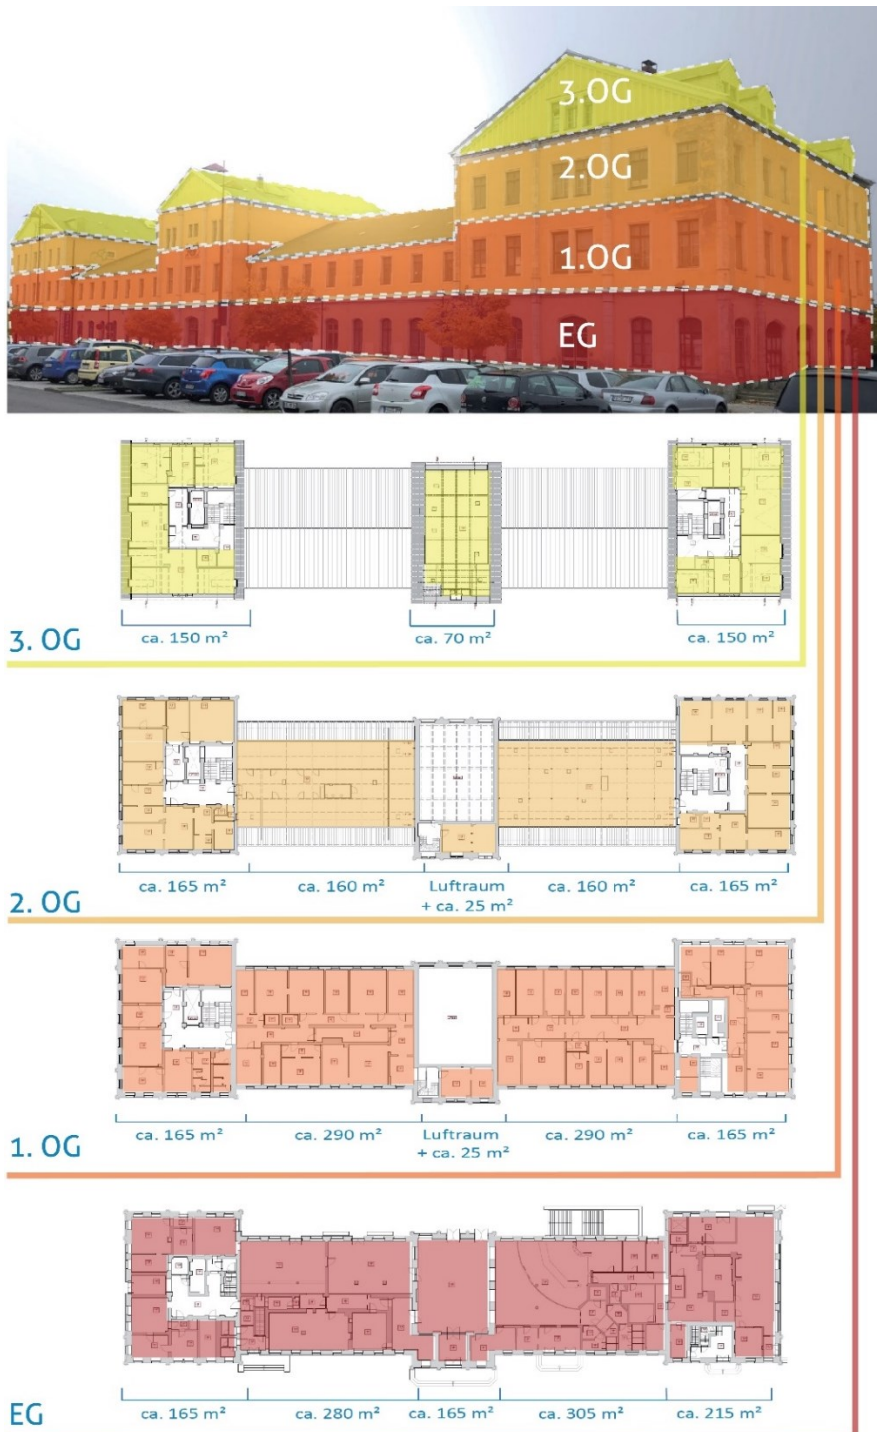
Grundrisse des Empfangsgebäudes im Bestand
